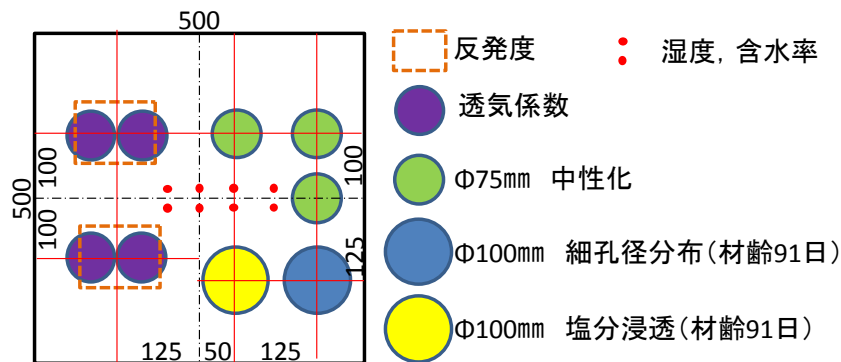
各試験における測定位置とコア供試体採取位置 (単位: mm)
